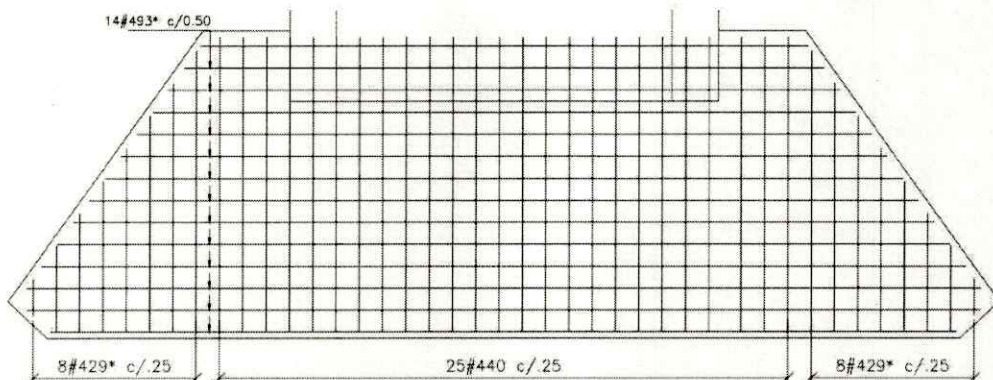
Geometría inferior Losa fondo de cabeza de salida Box Culvert 4m X 4m
